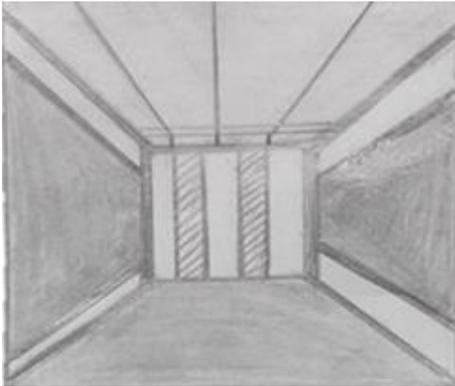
Alzado de la Conceptualización Arquitectónica
